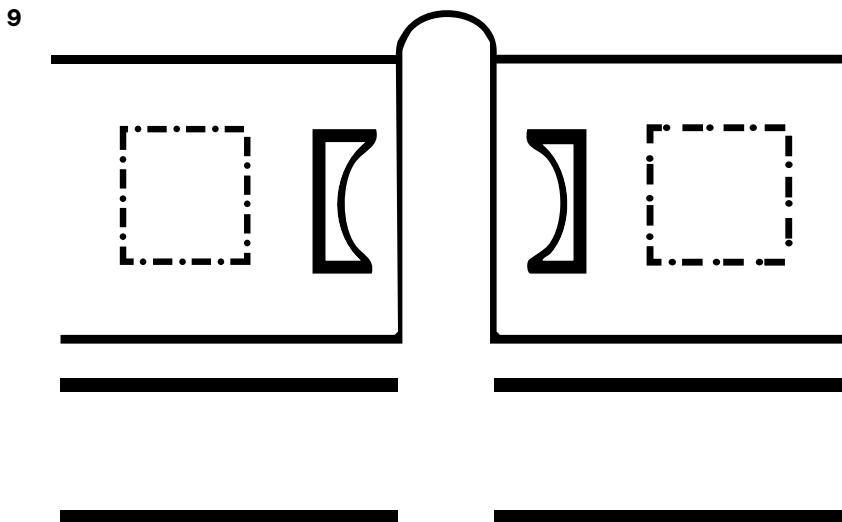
Final del sector D, con los cuatro pilares de una posible torre en fachada.
